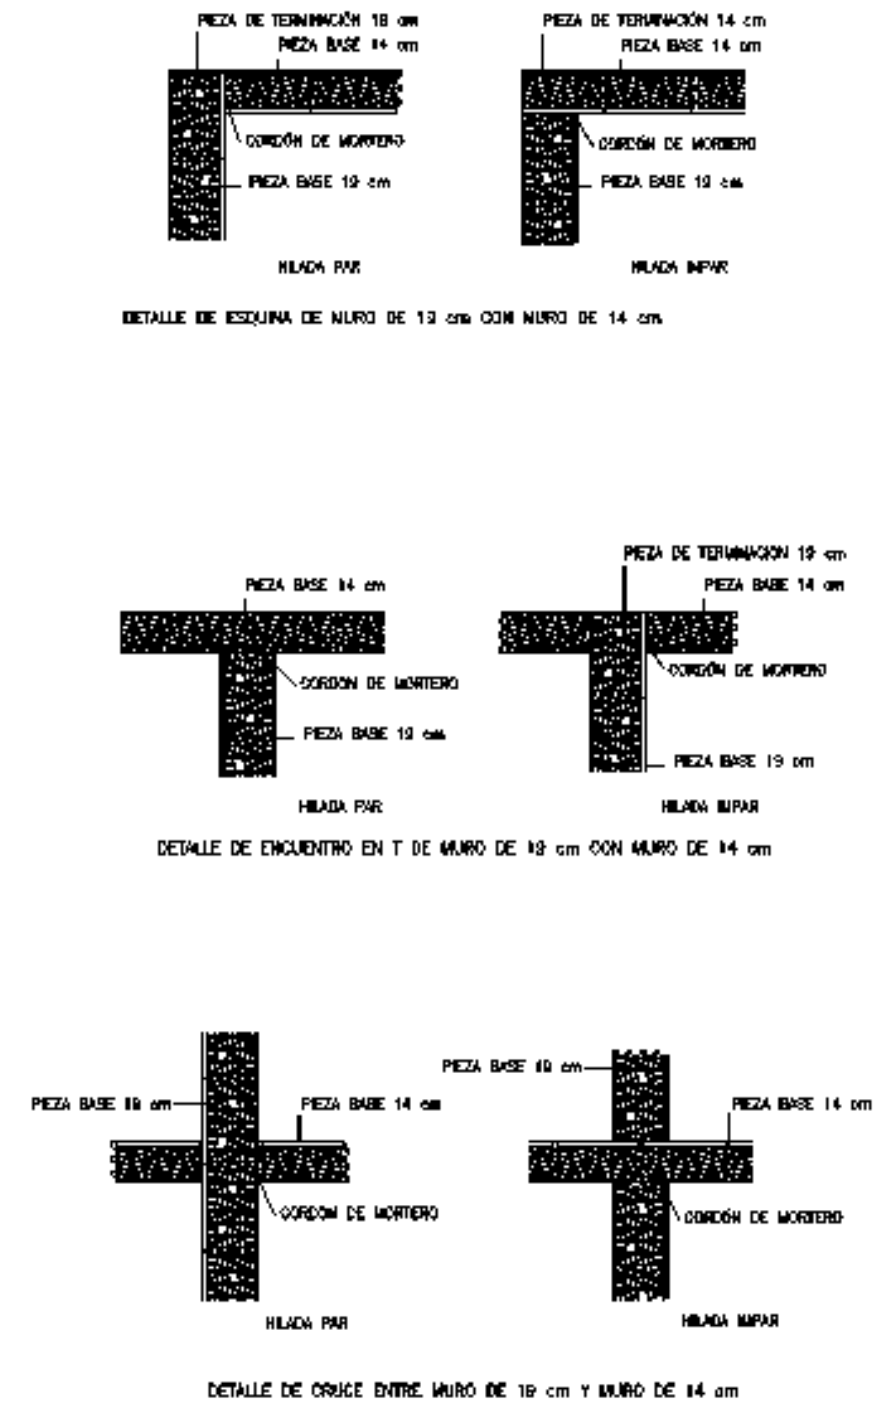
Detalles de encuentro de piezas de 19 cm con piezas de 14 cm.
